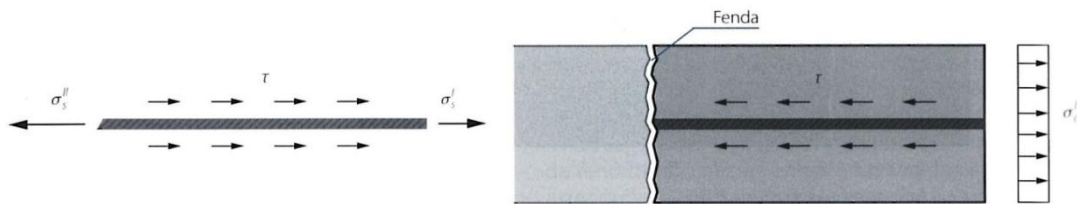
Aumento da extensão de um tirante de betão armado [4]
